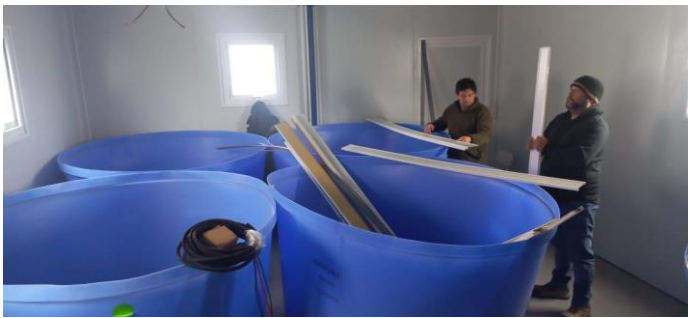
, 2 y 3 Trabajos en Planta Biofiltro "Sector Base"
